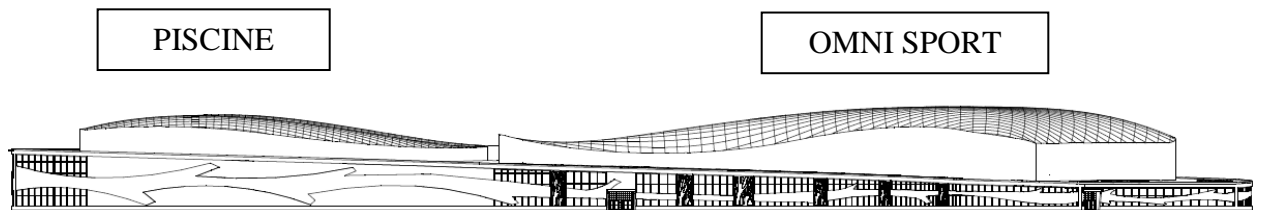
Façade sud du centre sportif Oued Falli ⁽⁶⁾
